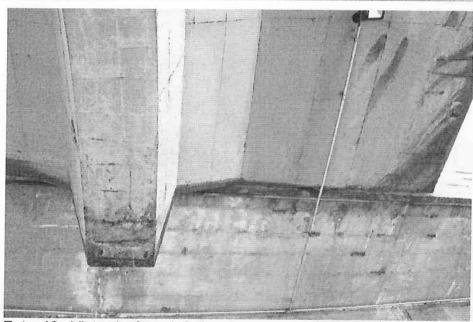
Vista da face inferior do encontro entre a passarela e o viaduto da Av. Brasil, apresentando armadura exposta na viga de travamento, eflorescência na laje, infiltração e a tubulação de instalação elétrica.
